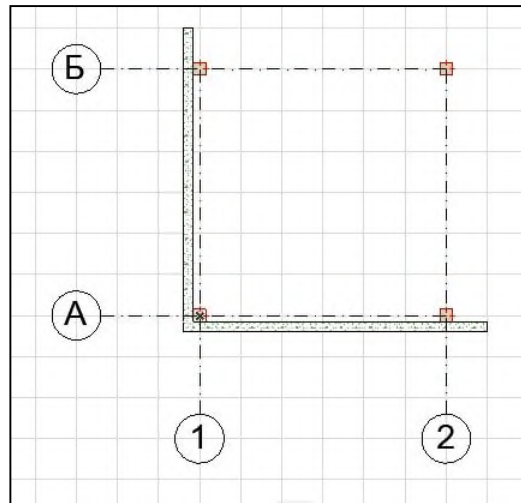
Фрагмент плану будівлі каркасного типу
